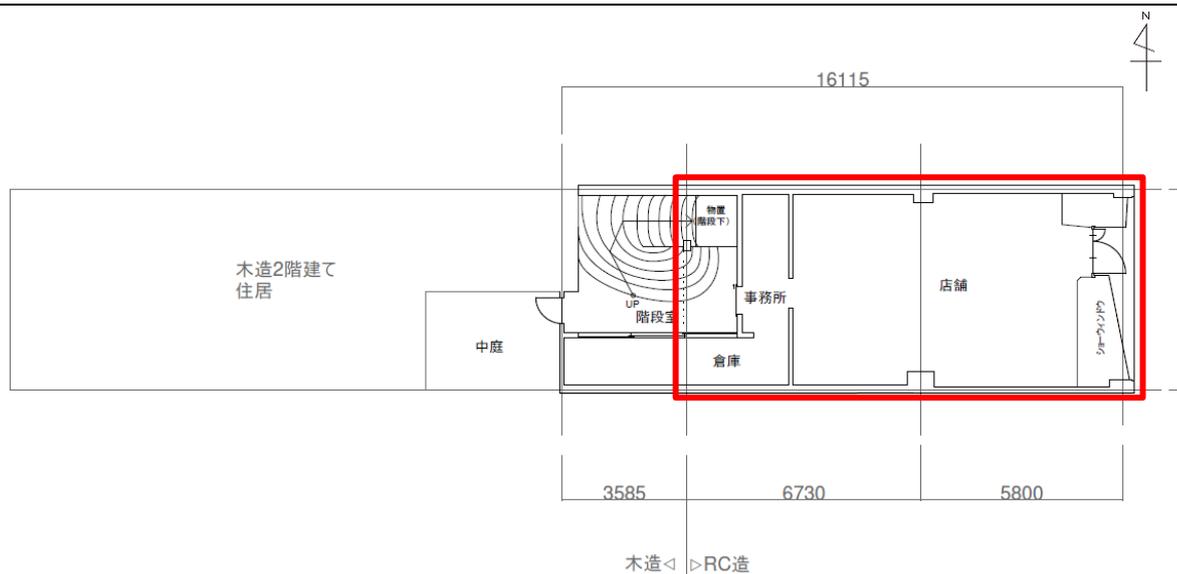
1 階平面図 (2024 年 11 月実測)
